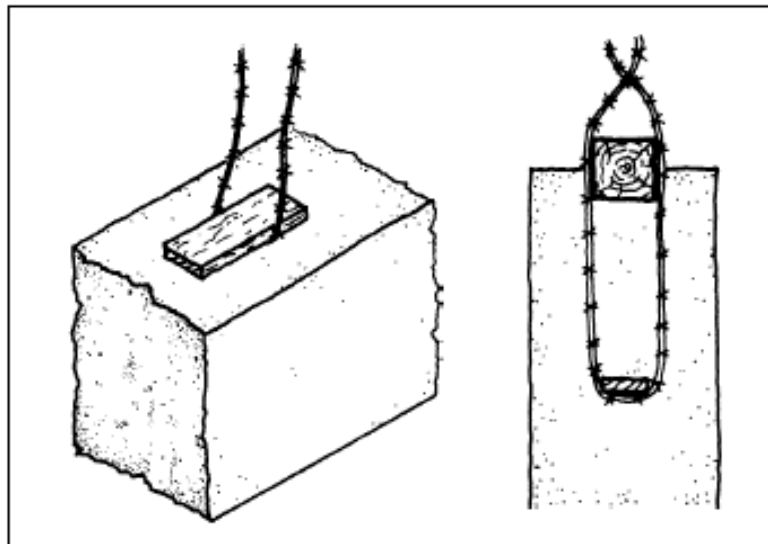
Anclaje del encadenado con el muro de tapial.
